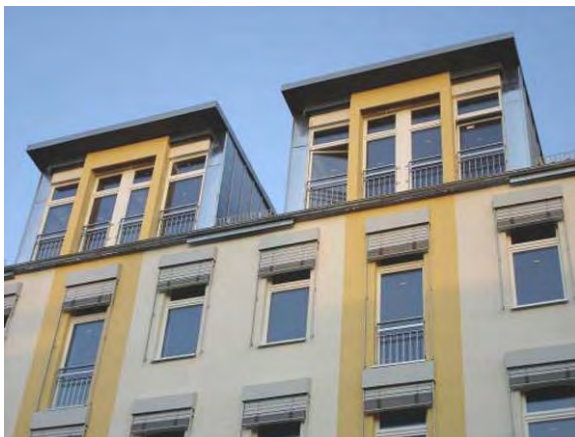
Wohnhaus Schneiderberg 17, Detail
